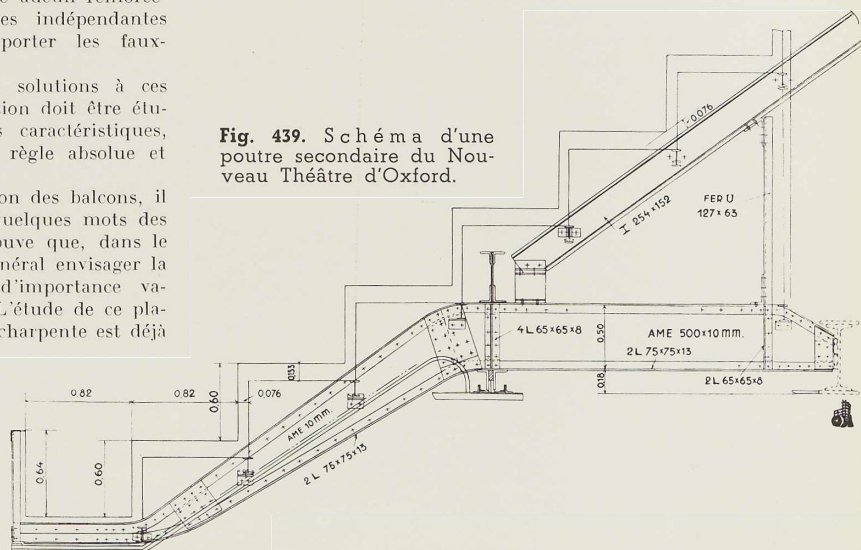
Schéma d'une poutre secondaire du Nouveau Théâtre d'Oxford.
